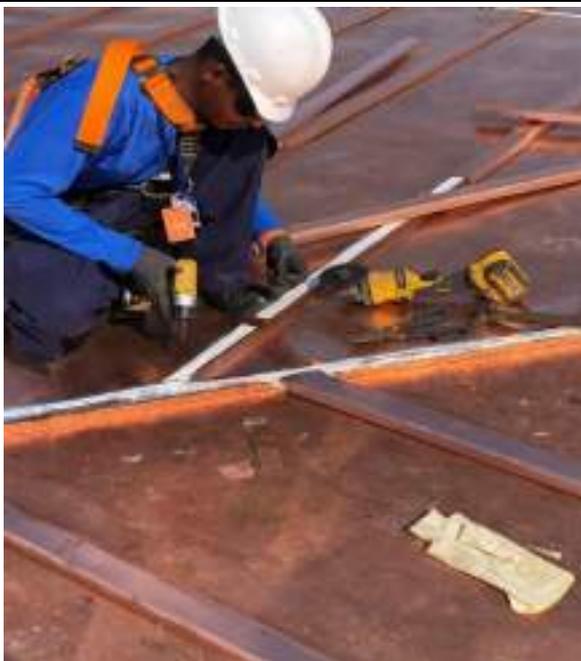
Conservação da cobertura, instalação de telhas em cobre e caibros de junção.
